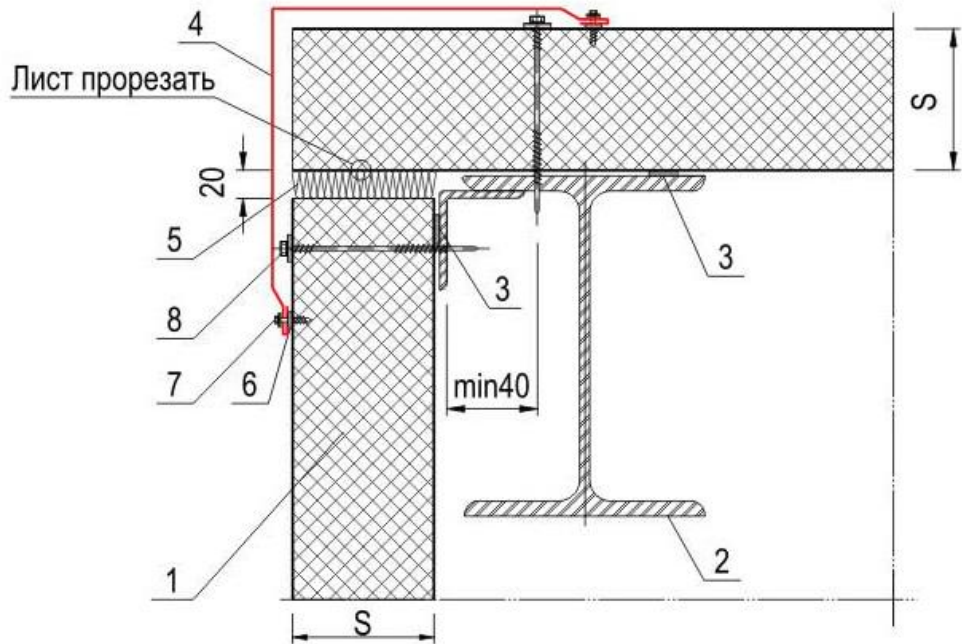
Конструкция стены на основе сэндвич-панелей: деталь разреза по продольной стене:
